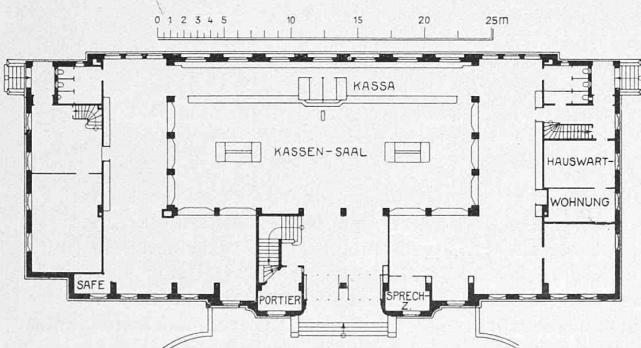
Oesterreichisches Verkehrsbureau. Erdgeschoss-Grundriss 1:500.
